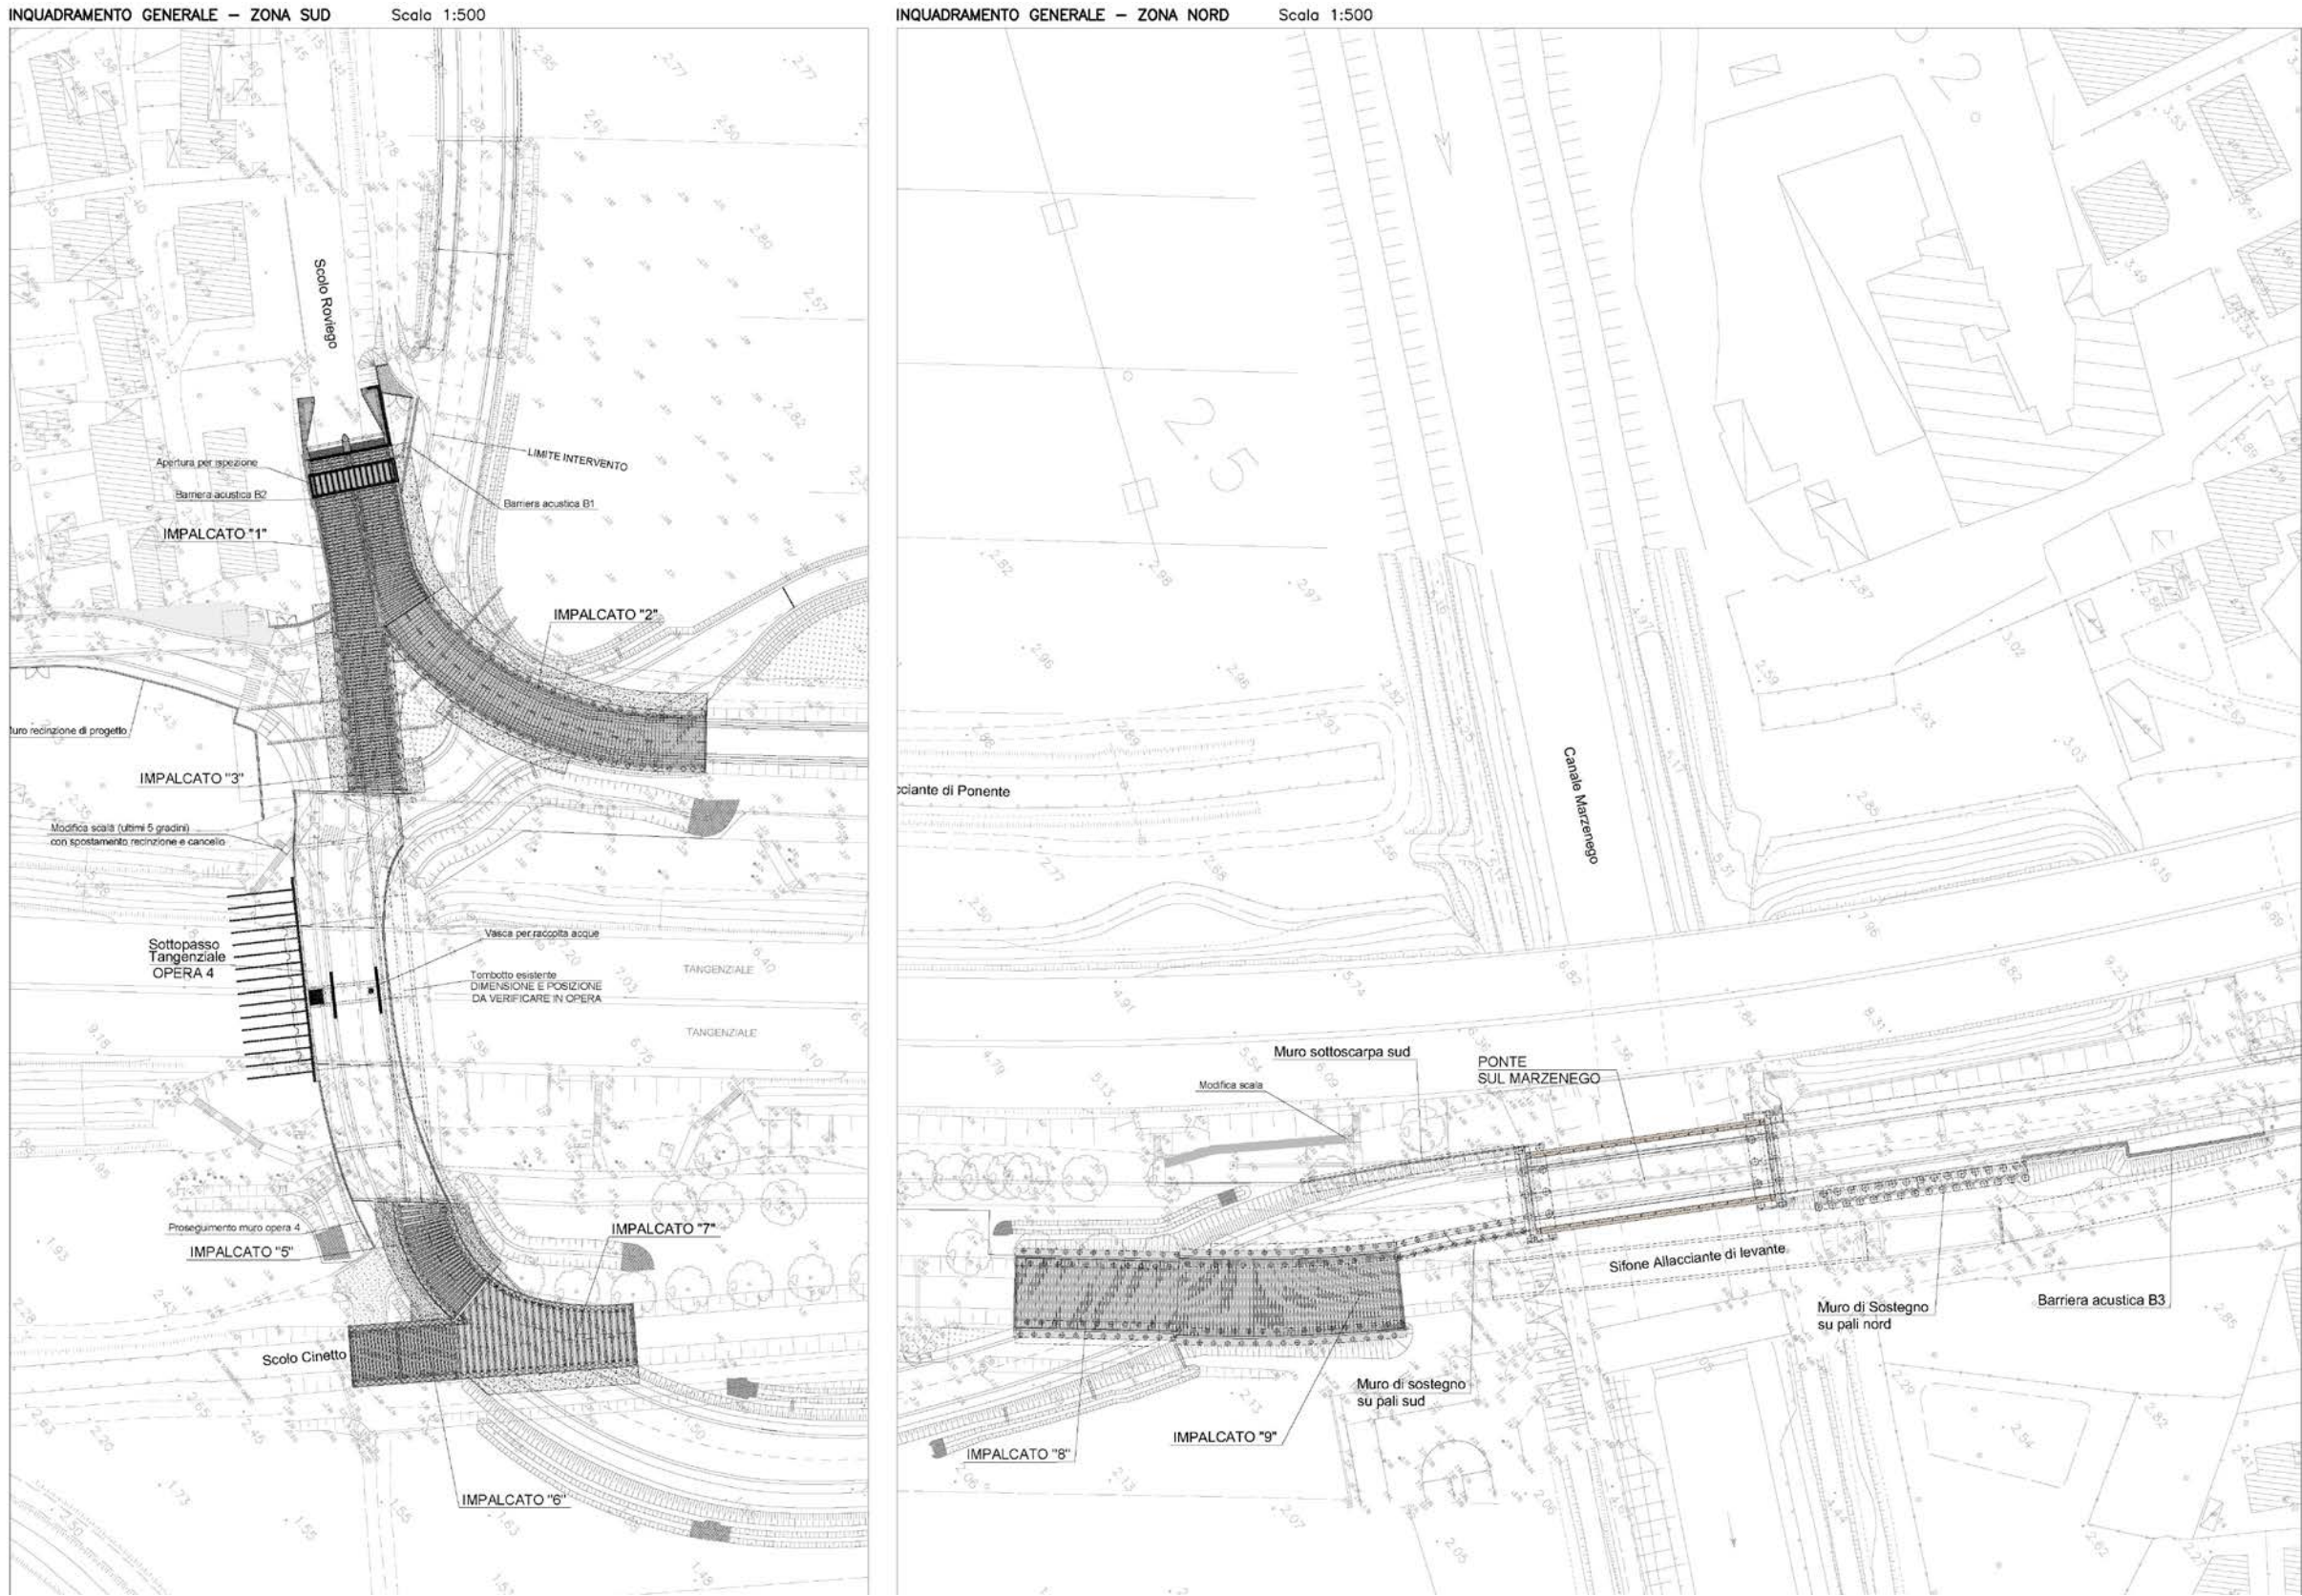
Opere d’arte – Planimetria d’inquadramento
